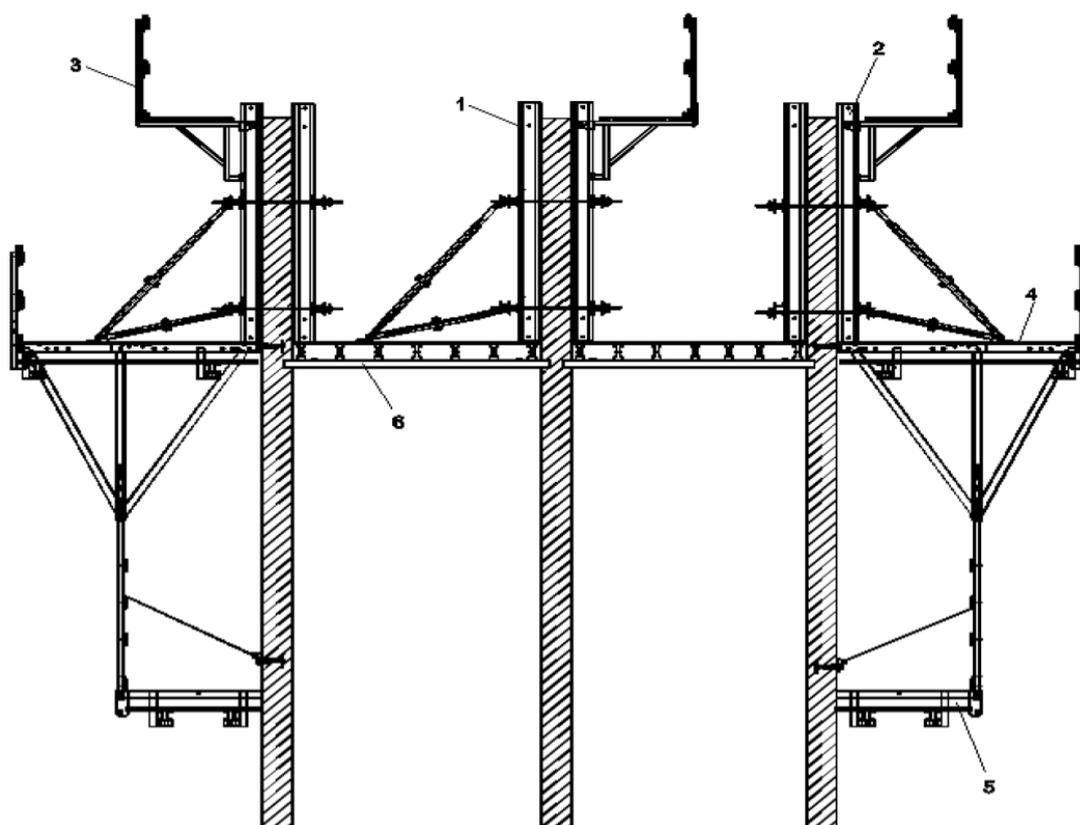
Схема устройства подъемно-переставной опалубки лифтового блока 1 – внутренние блоки из щитов опалубки; 2 – наружная опалубочная панель; 3 – навесные подмости для бетонирования; 4 – рабочие подмости; 5 – нижние подмости; 6 – рабочая площадка шахты лифта с самофиксирующимися упорами
